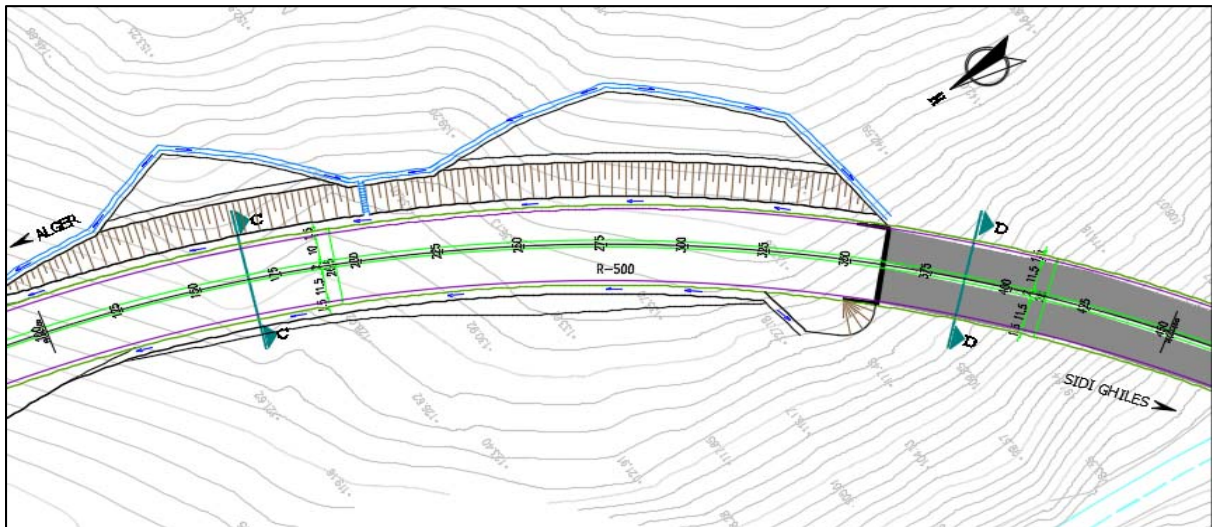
Trace en plan du tronçon PK4+100 au PK4+450
